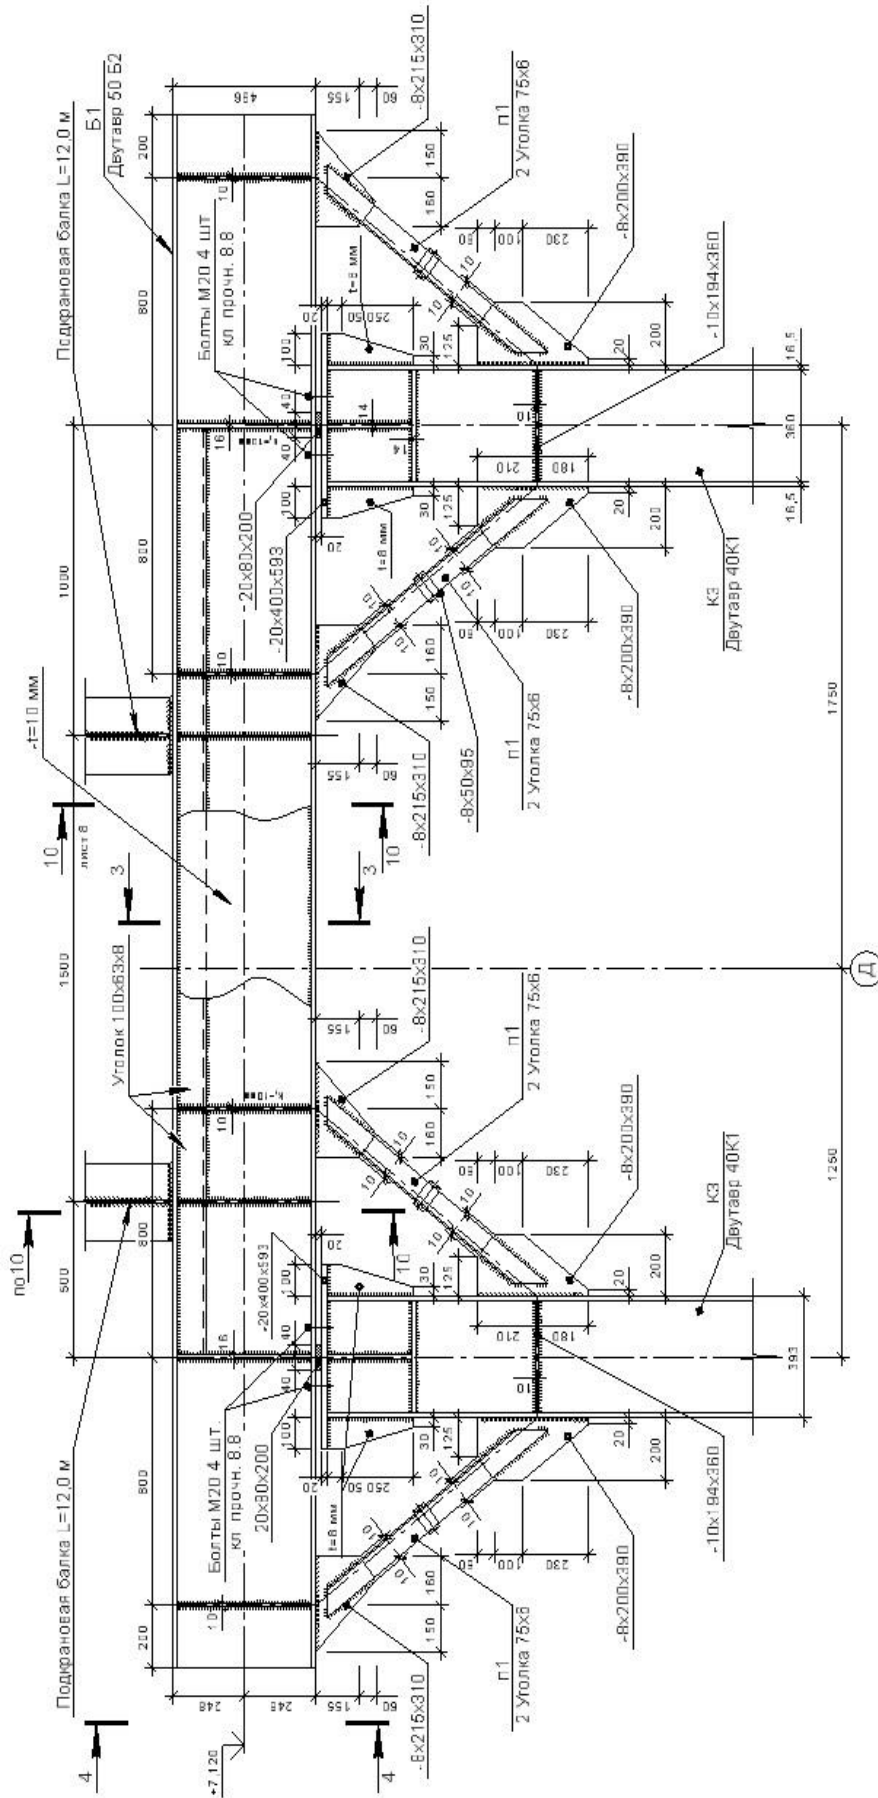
Фрагмент проектной разработки опорной поперечной рамы усиления подкрановых балок пролетом $L=12,0$ м по ряду «Д»
